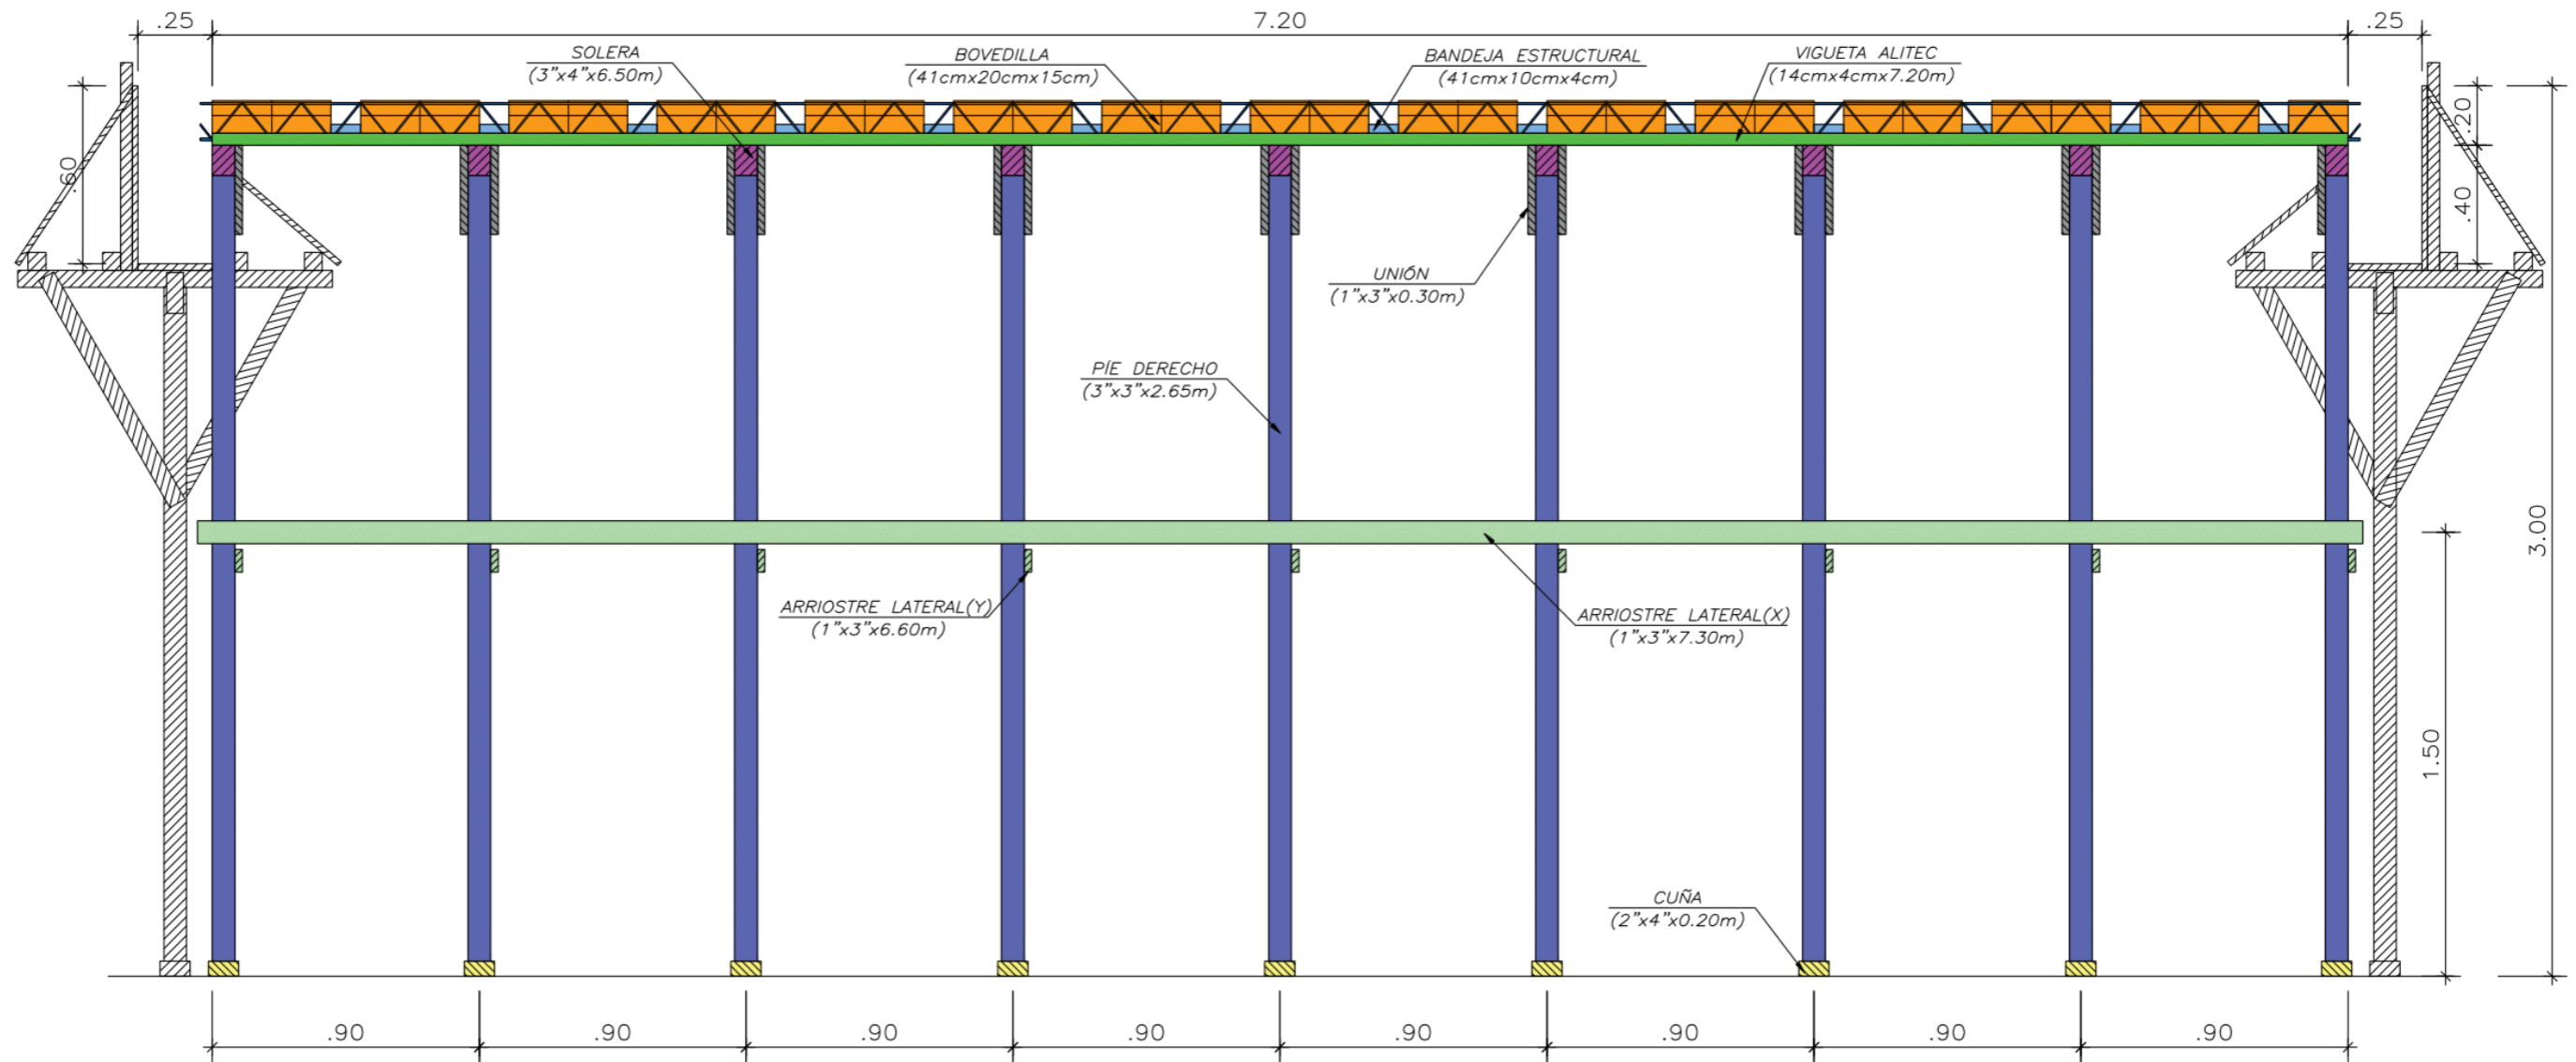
Corte Longitudinal C – C, para la Losa Aligerada Bidireccional Prefabricada Alitec.
